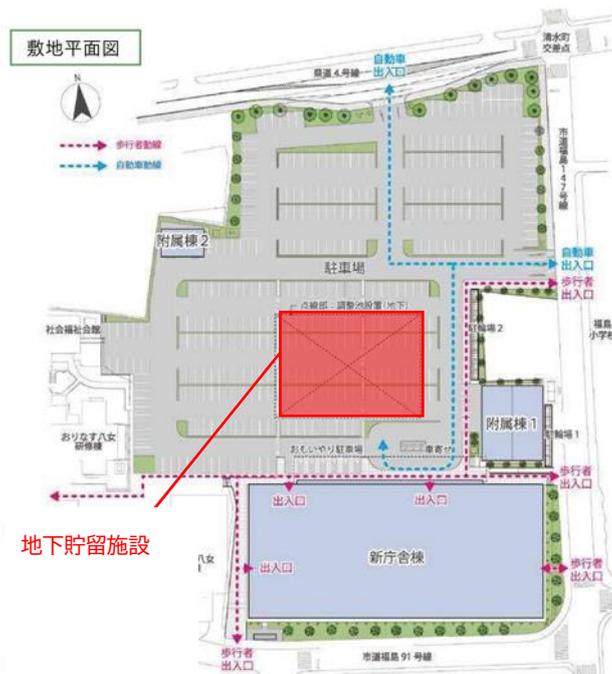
市庁舎敷地計画平面図(八女市HPより)
